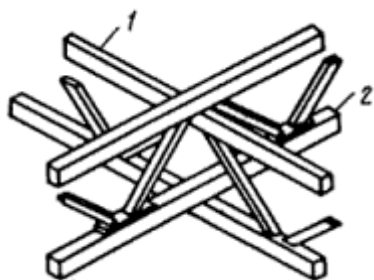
Сопряжение перекрестных металлических ферм
